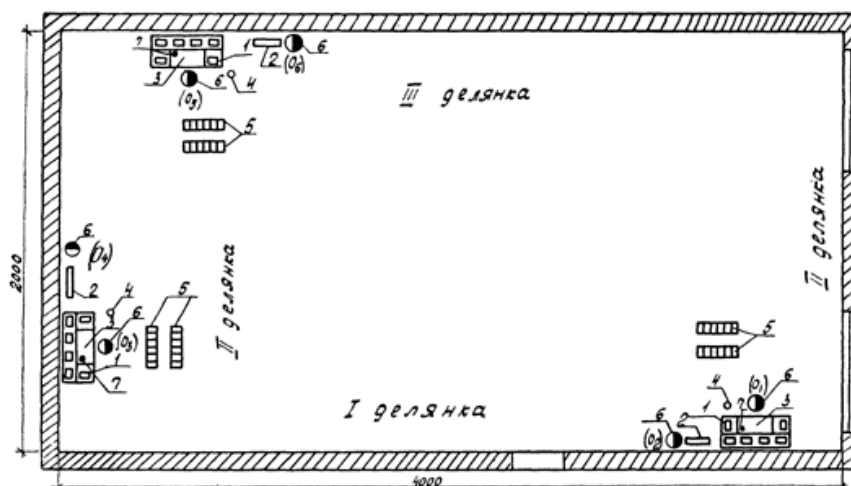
Схема организации работ по облицовке стен полистирольными плитками: 1 – плитки; 2 – скамейки; 3- столик; 4 – ведро с водой; 5 – рамки с плитками; 6 – рабочее место плиточников-облицовщиков; 7 – банка с мастикой
